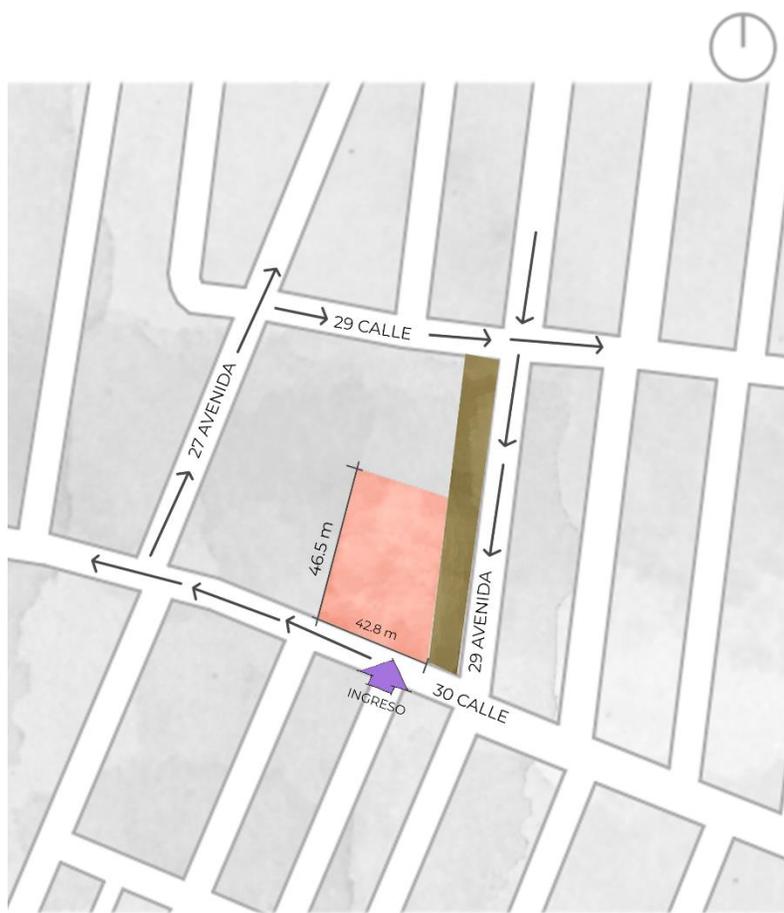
"Análisis de Sitio: Accesos, Colindancias y Construcción existente". Elaboración propia.
